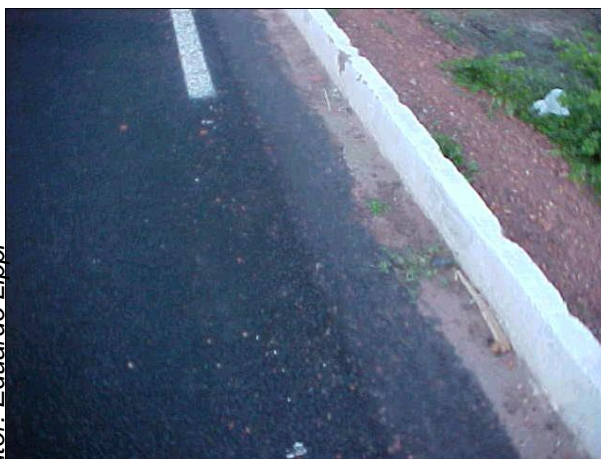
Ligação Ilha Grande – PI – 116 (4km. de Parnaíba), pavimento 118 precário
